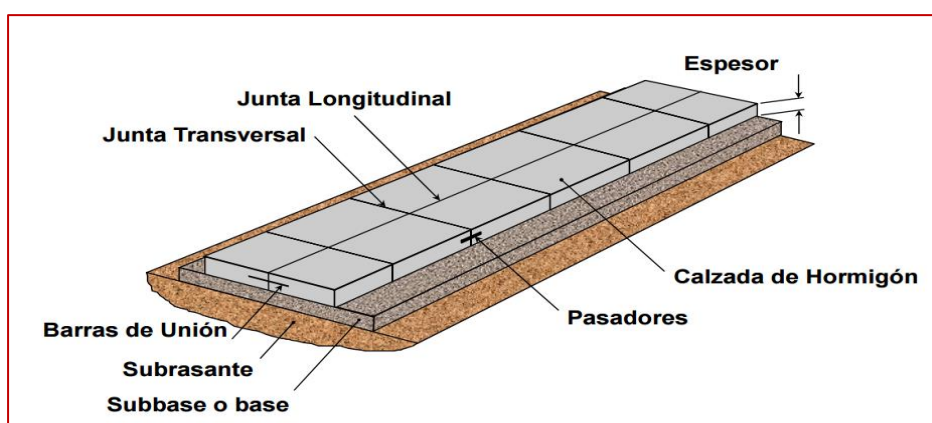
Esquema típico del paquete estructural de un pavimento rígido.
